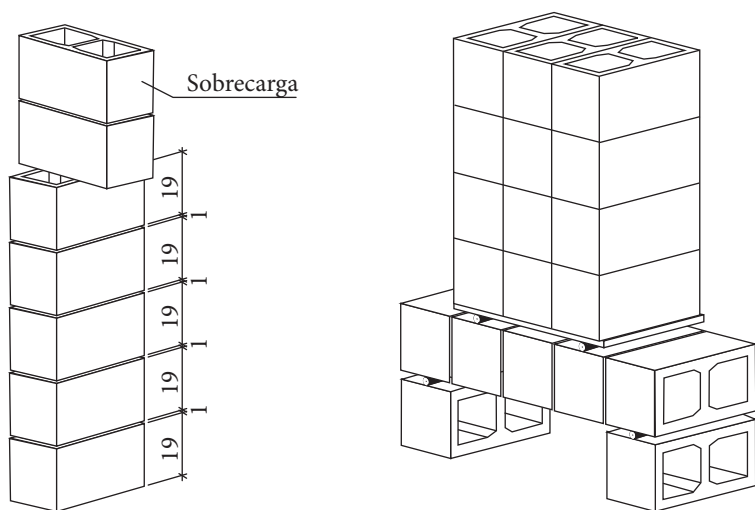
Procedimento de moldagem (prisma de 5 fiadas) e ensaio em obra de tração na flexão de alvenaria.
